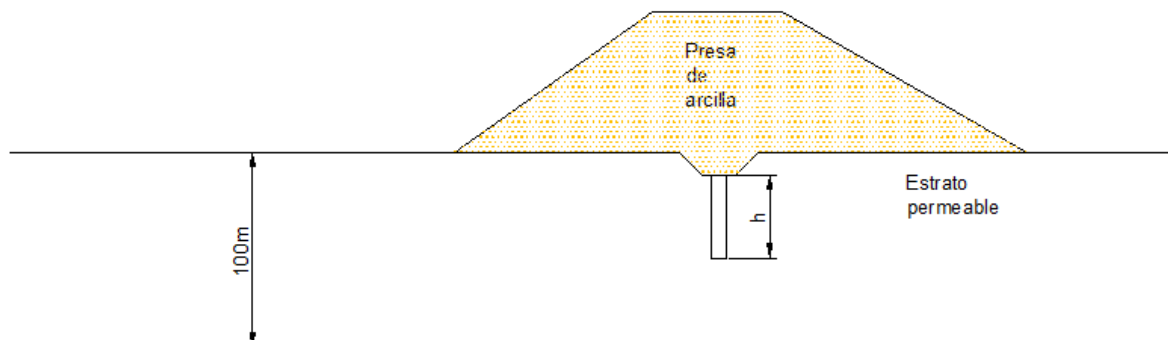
Geometría de la presa con pantalla colgante de hormigón plástico
